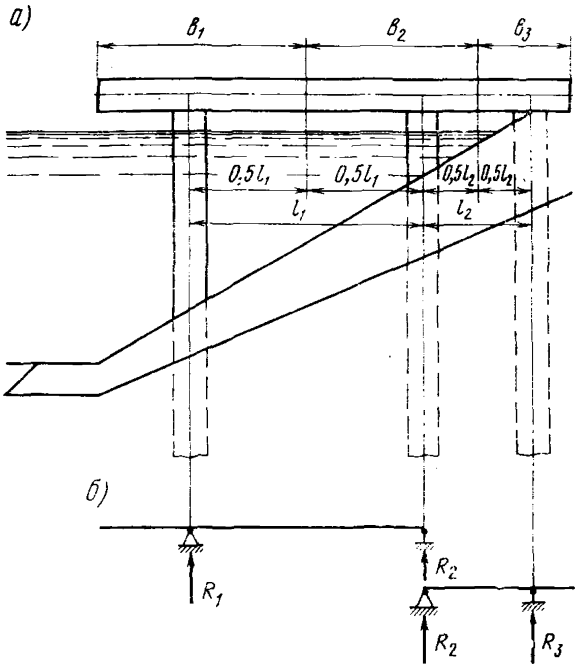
Составление расчетной схемы: а — поперечный разрез сечения набережной-эстакады; b_1, b_2, b_3 — ширина условных ригелей соответственно 1, 2, 3 продольных рам; б — разбивка ригеля на однопролетные балки для предварительного определения нагрузок на сваи
